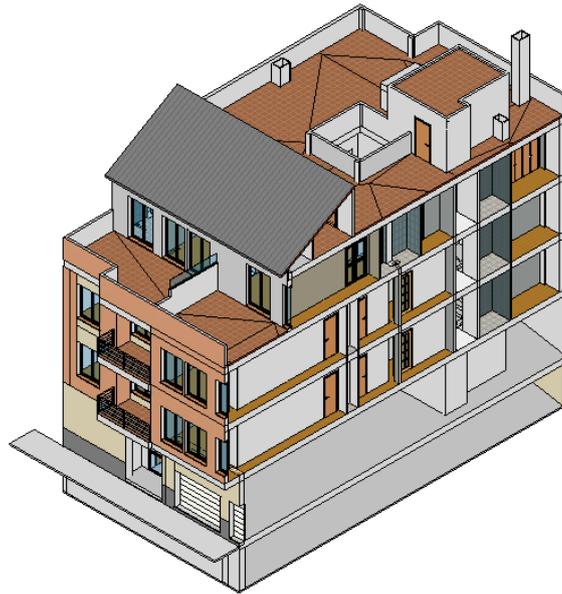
Modelo con pinturas y la carpintería exterior e interior, 2014.
